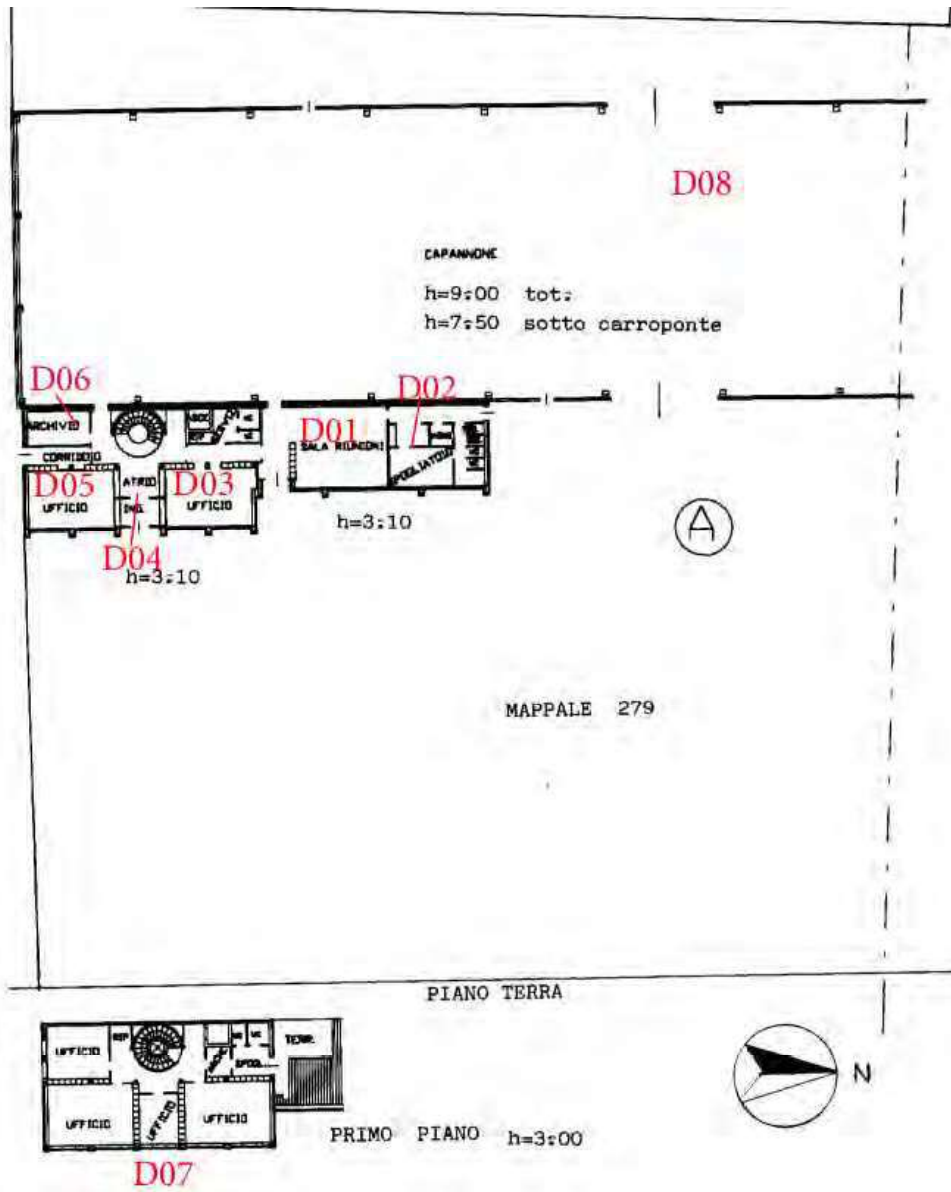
Ficarolo - Capannone D - Planimetria con indicazione locali
